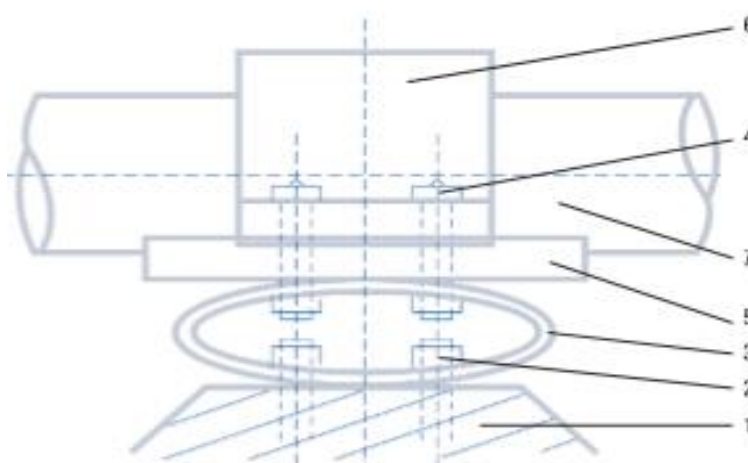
Конструкция анкерной опоры надземных трубопроводов, проложенных в сейсмоопасных участках
